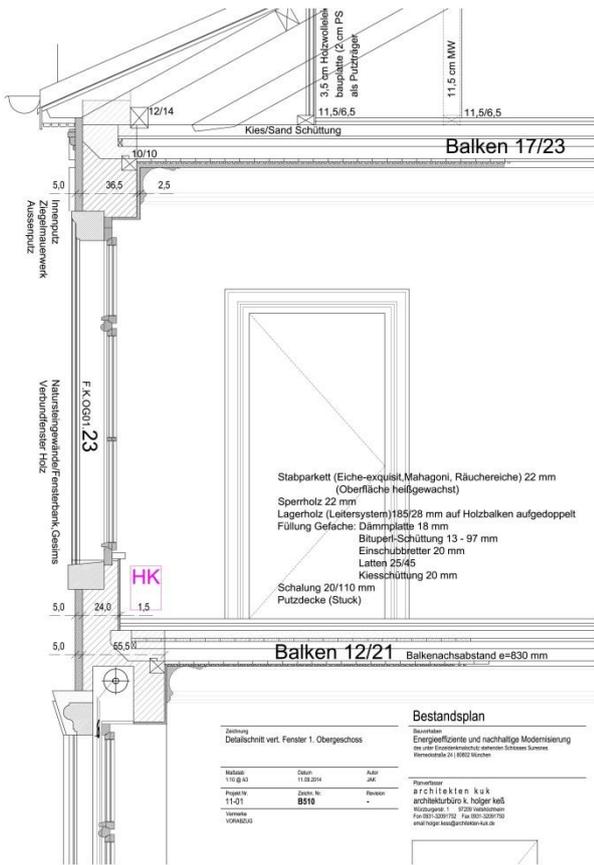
Detailschnitt Deckeneinbindung, Architekten Keß und König
